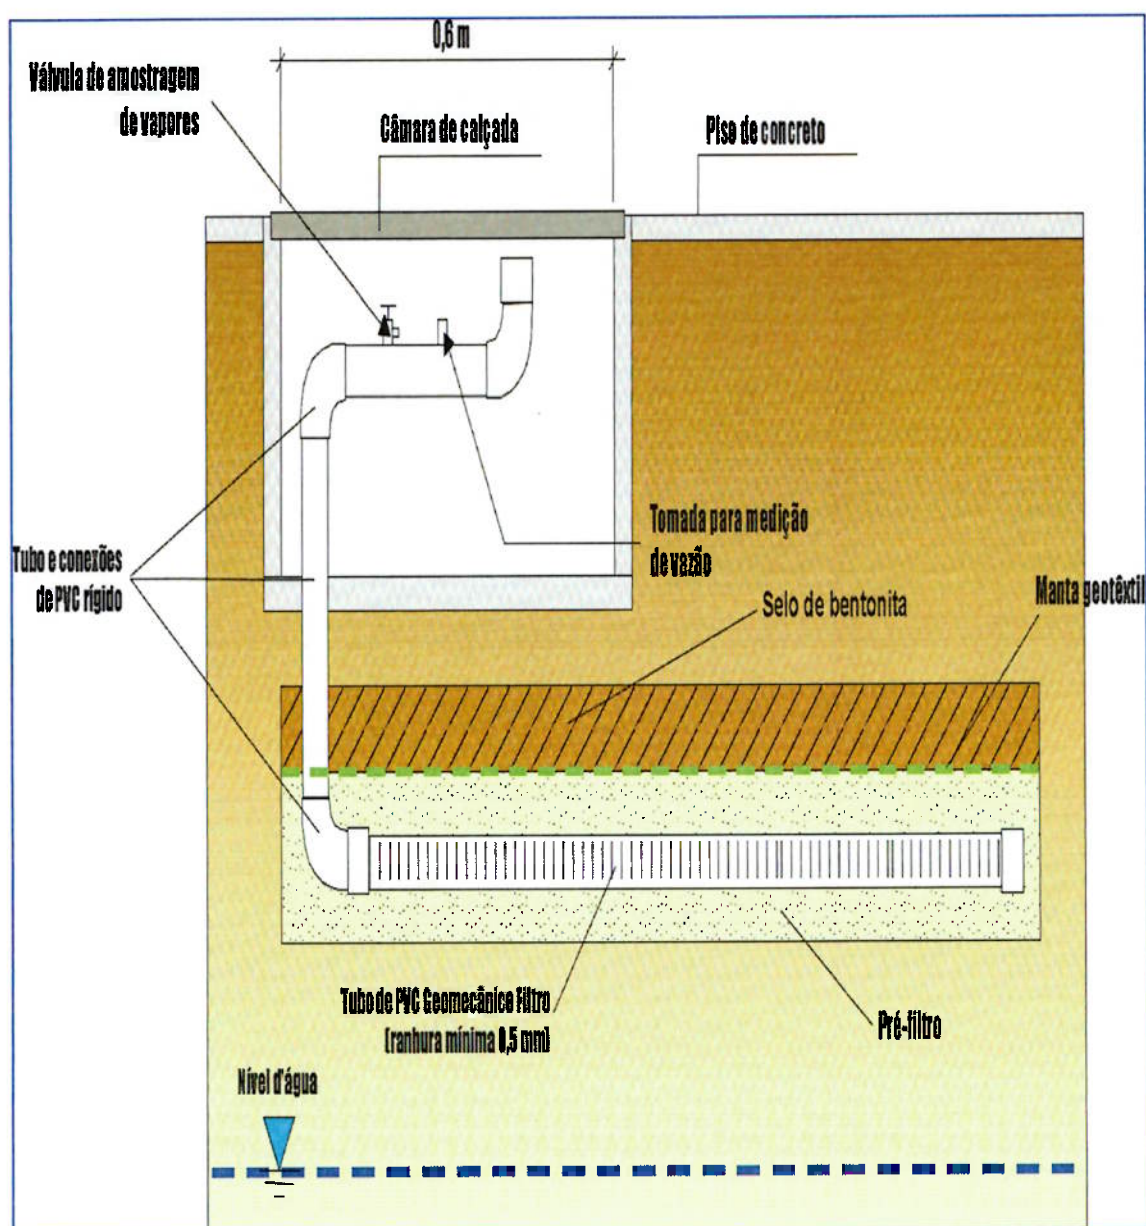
Seção ilustrativa do sistema instalado na zona insaturada. Fonte: projeto ANGEL.
